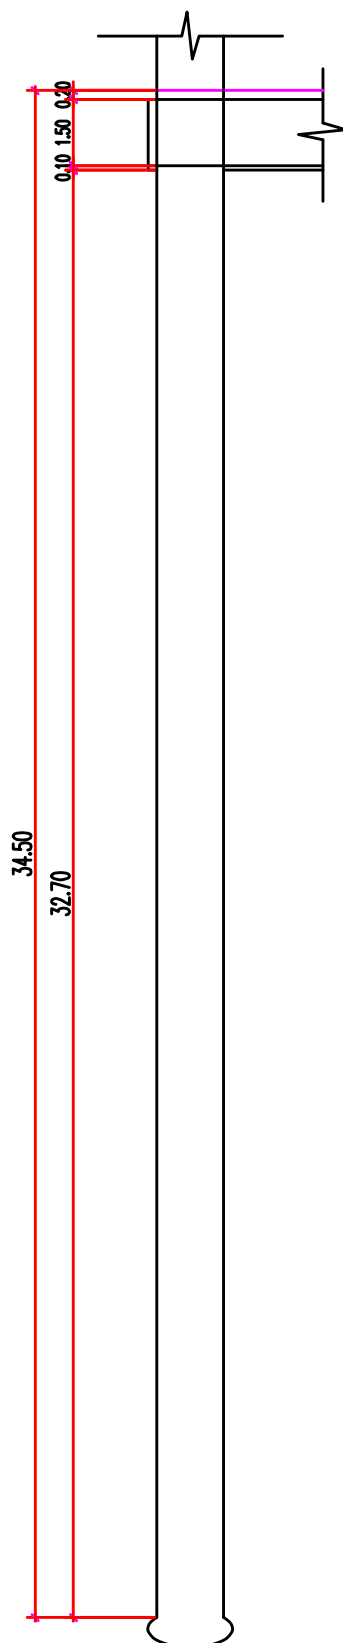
Pilar SVA4: Zona Enterrada no Solo
